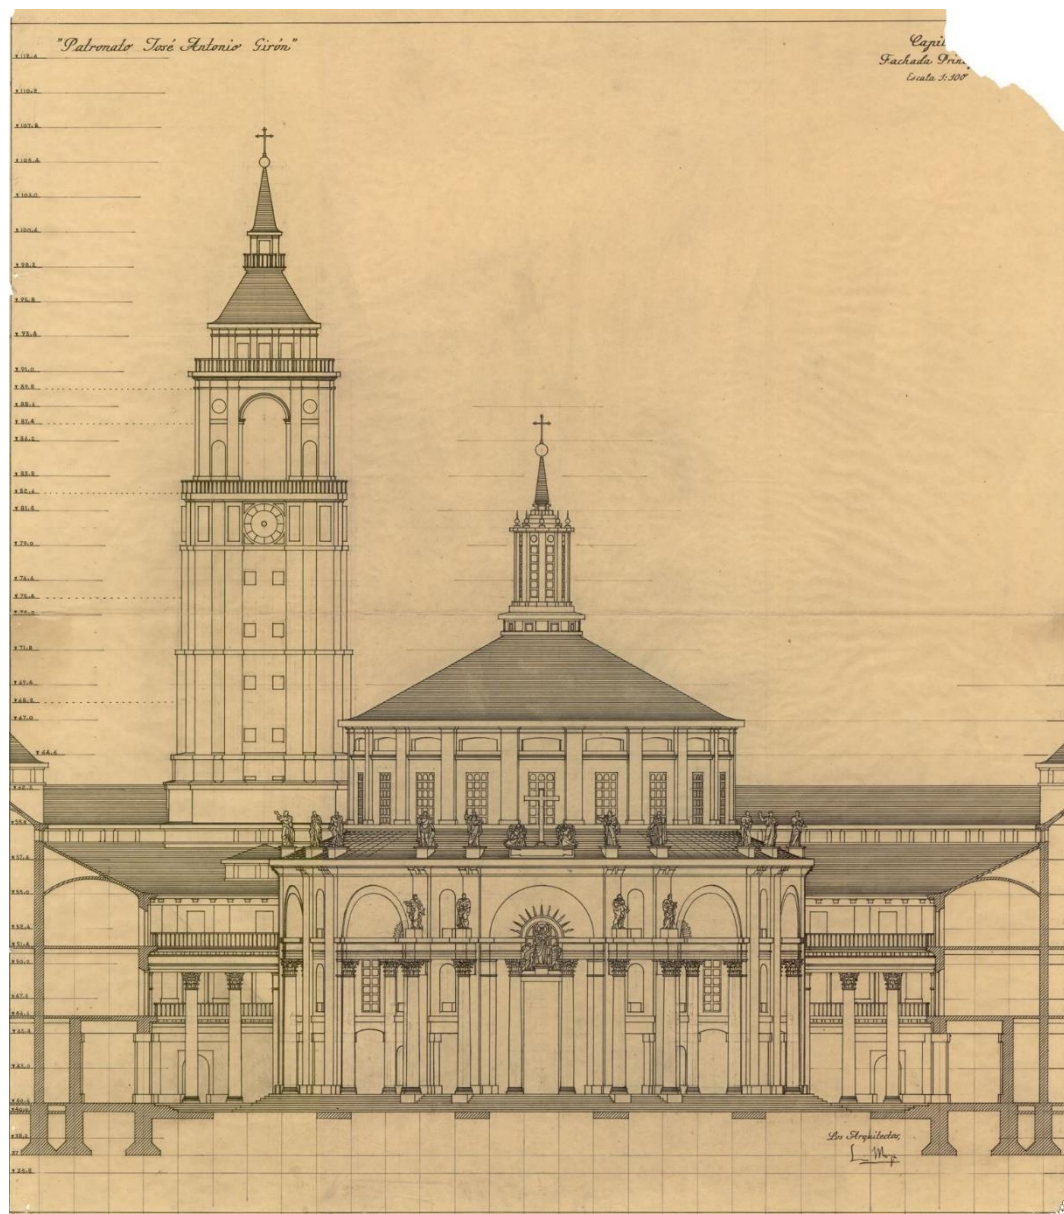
Alzado fachada principal de la Iglesia y la Torre. Dibujo de Luis Moya.
